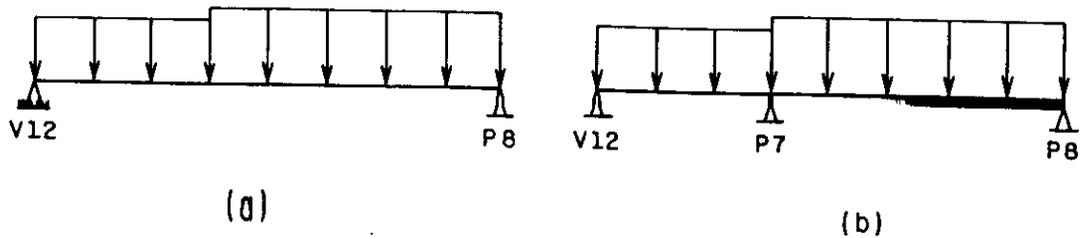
Estudo da Viabilidade da Introdução dos Pilares P7 e P10 da ESTRUTURA III
